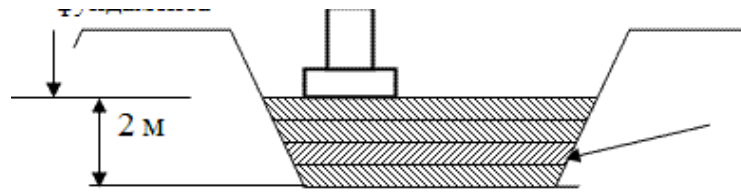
Схема усунення просідання лесового ґрунту пристроєм ґрунтових подушок
